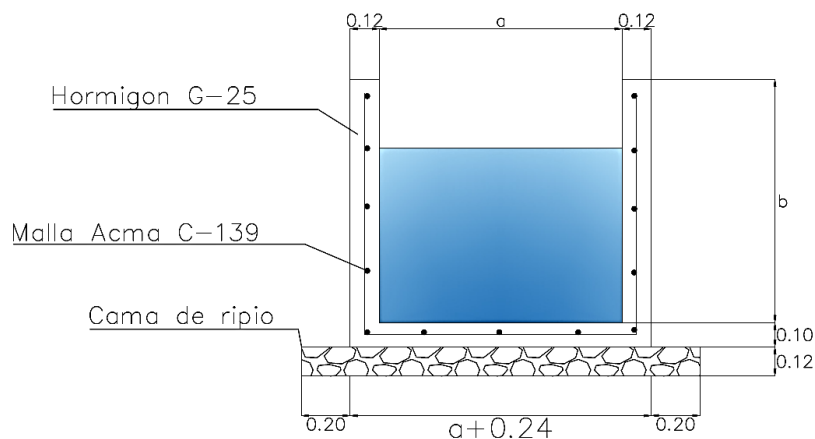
Detalle de sección canal tipo (en m). Fuente: elaboración propia.
